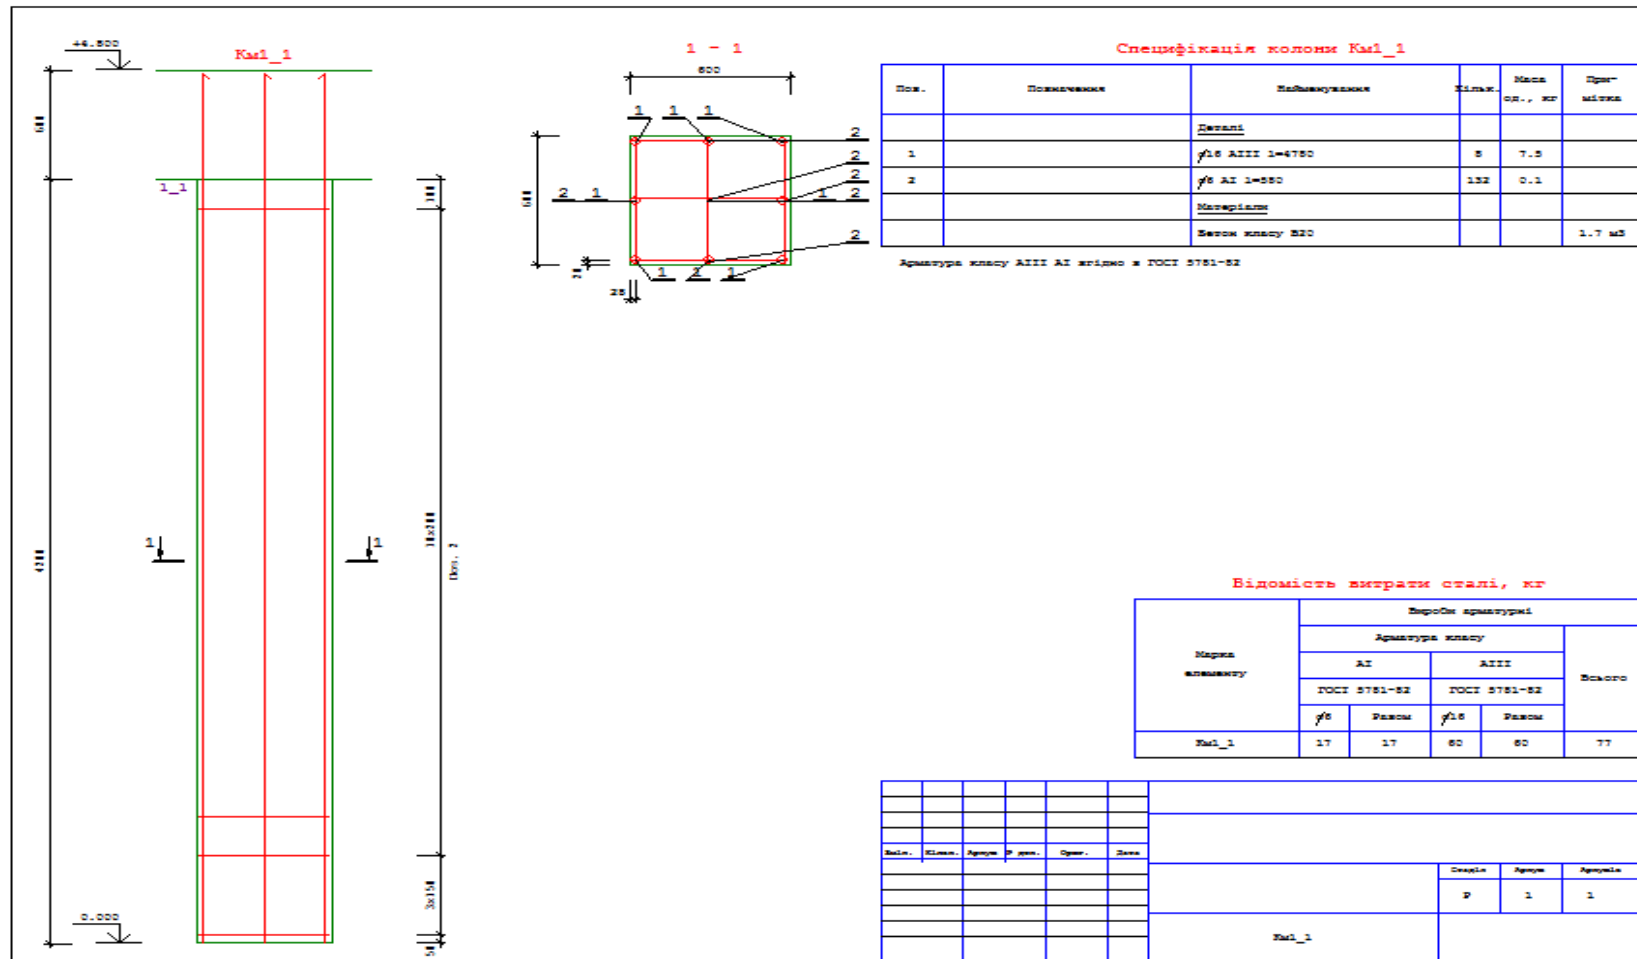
Варіант балочно - плитного перекриття. Колона К1-1. Креслення робочого проекту
